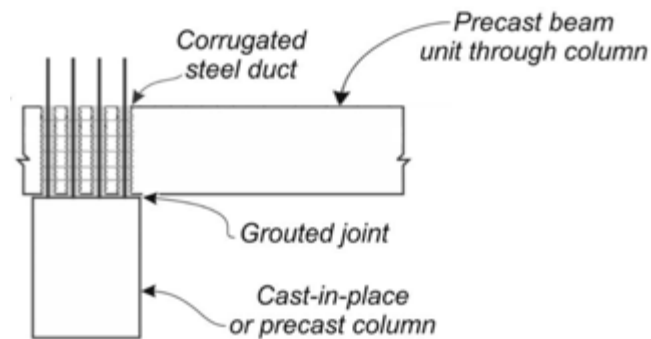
Conexión de vigas y columnas mediante vigas prefabricadas a través del nudo (Kurama et al., 2018).
